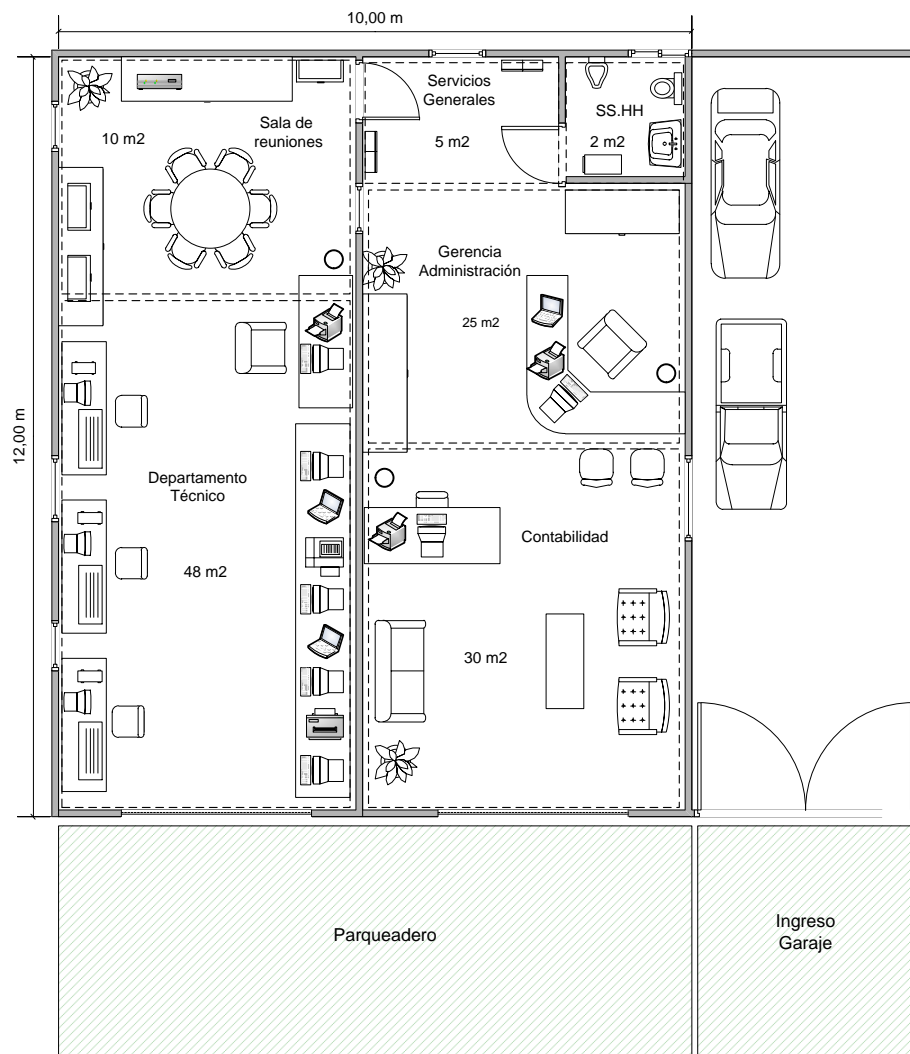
Plano de distribución de las instalaciones del proyecto
